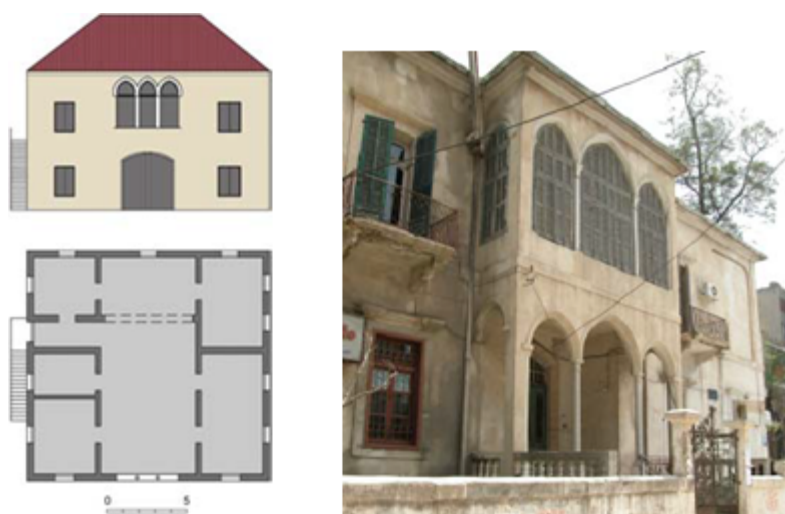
Planta e alçado da casa Libanesa; Fotografia da fachada.
